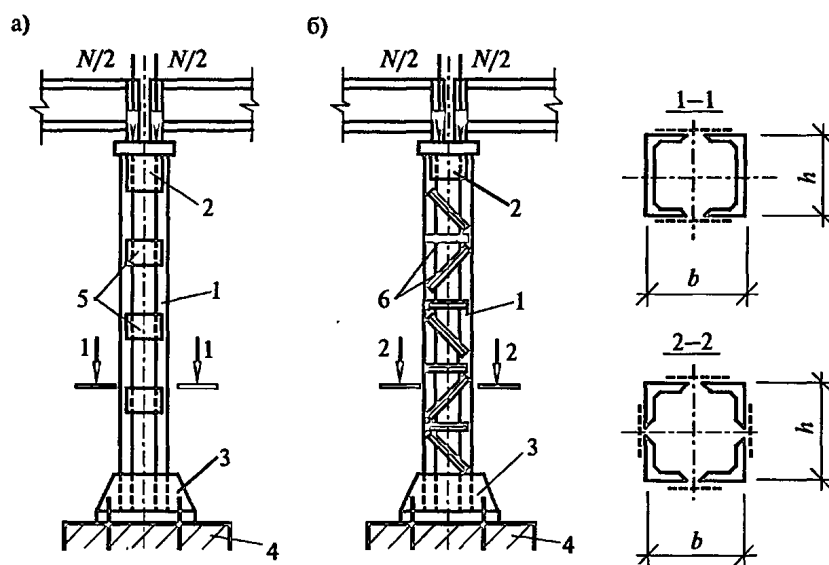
Сквозные центрально-сжатые колонны: а) соединение ветвей на планках; б) соединение ветвей решеткой из уголков; 1 — стержень; 2 — оголовок; 3 — база колонны; 4 — фундамент; 5 — планки; 6 — уголки
